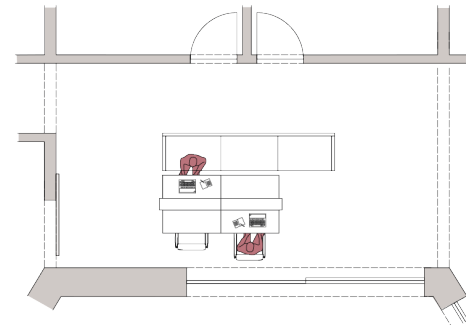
Grundrissvariante 2 - Individuell
